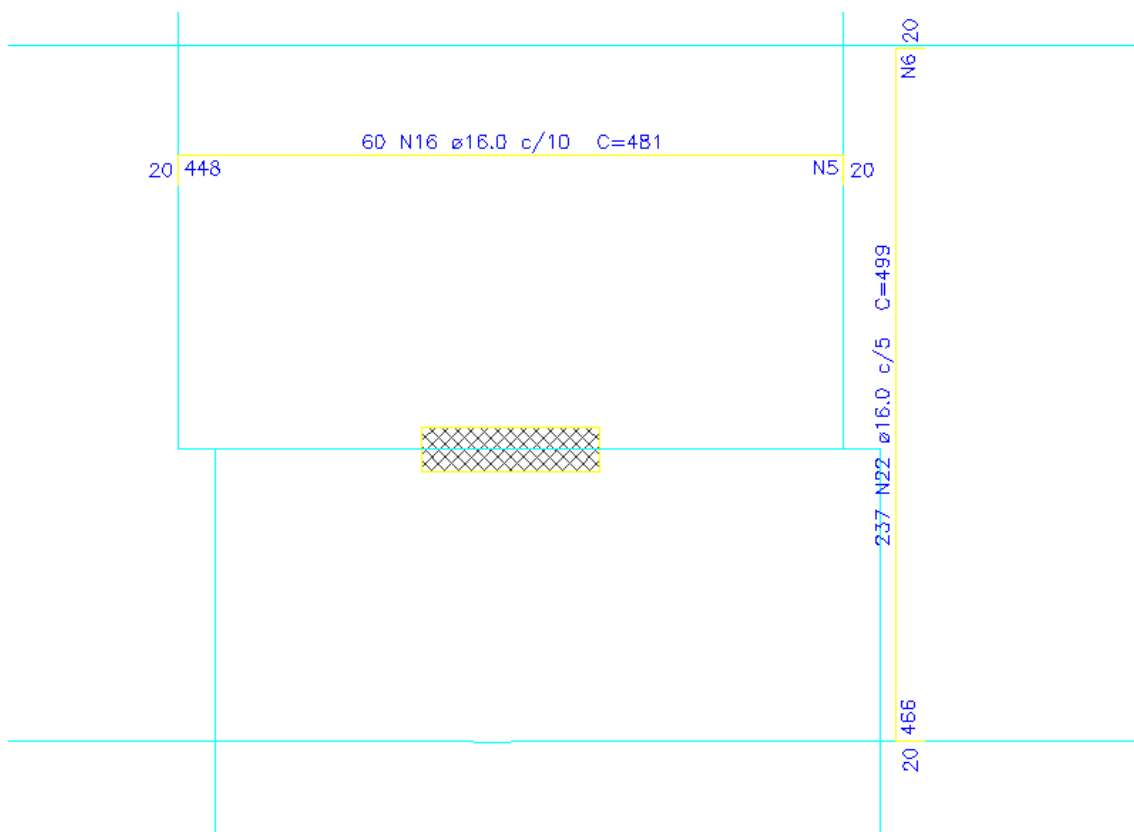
Detalhamento da armadura superior da laje lisa sobre o pilar P13 via Eberick
